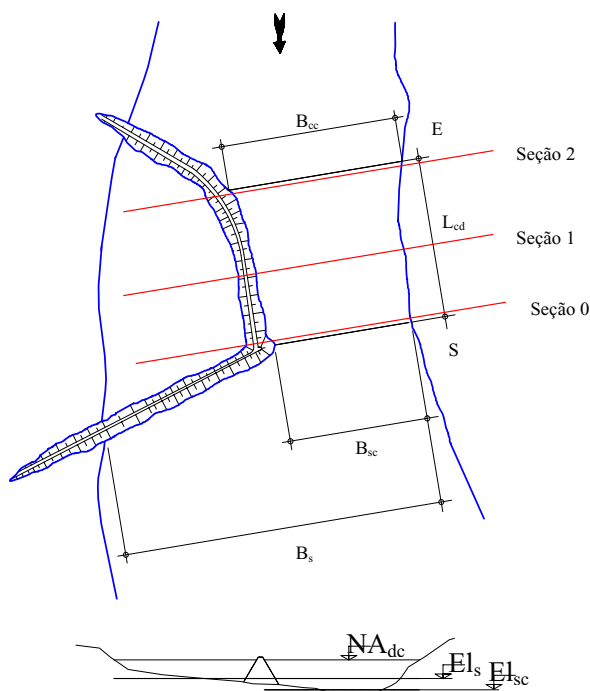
Planta e seção transversal típica de canal de desvio
